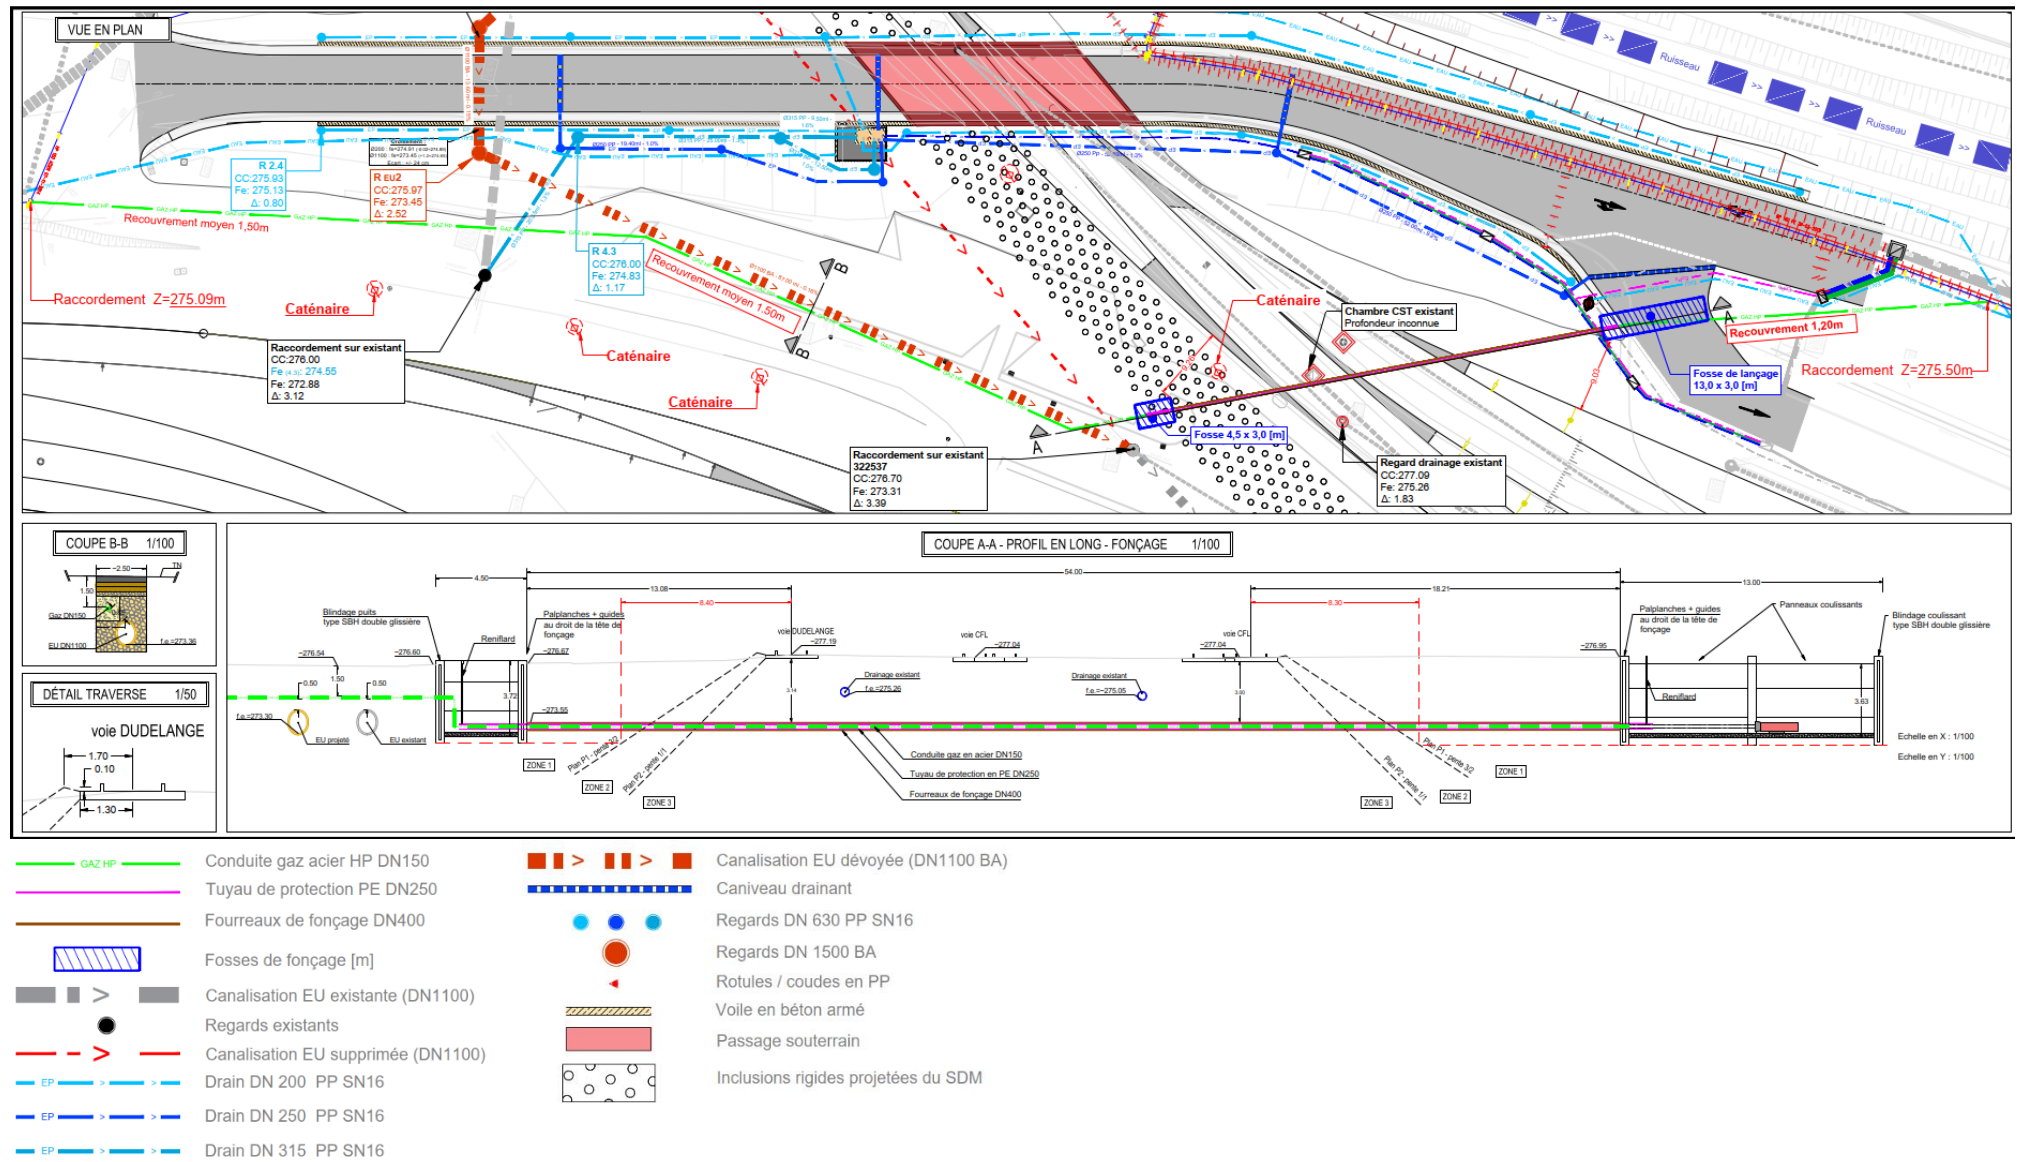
Auszug aus dem Plan APD (CFL). Vollständiger Plan im Anhang 04. Darstellung nicht genordet.
